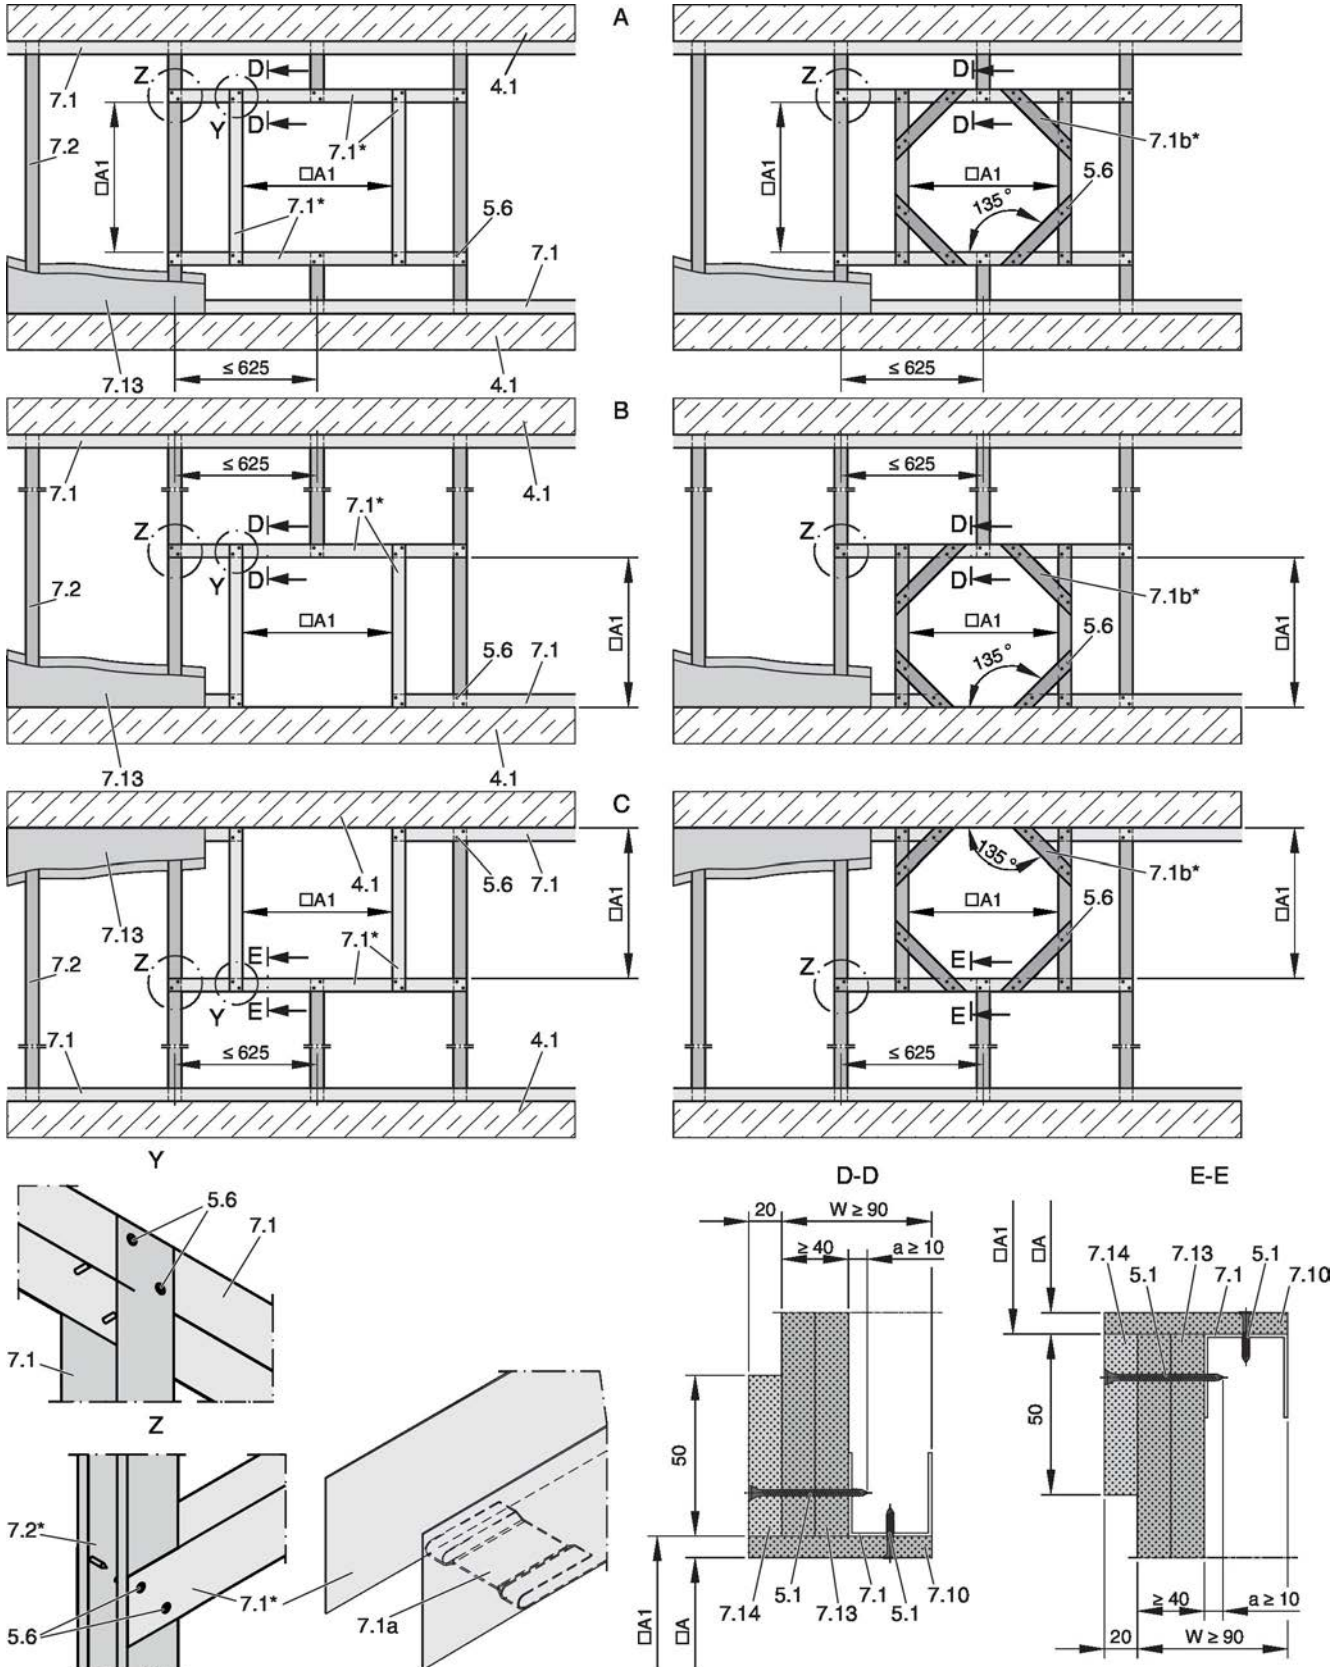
Schachtwand mit Metallständer und einseitiger Beplankung
